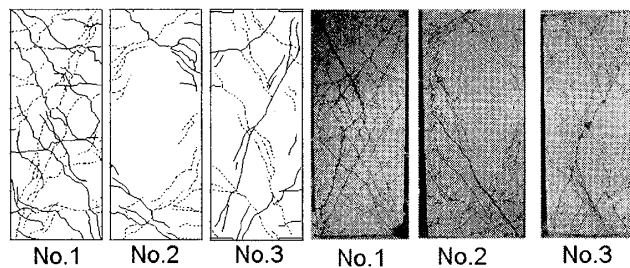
1/100 時ひび割れ図 写真 1 1/67 時ひび割れ
